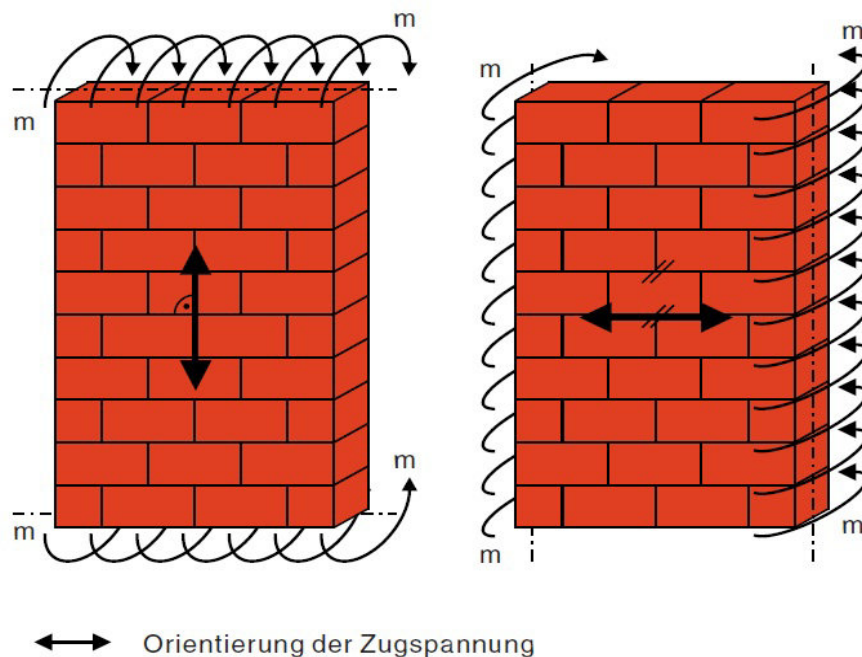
Biegebeanspruchtes Mauerwerk [13]
